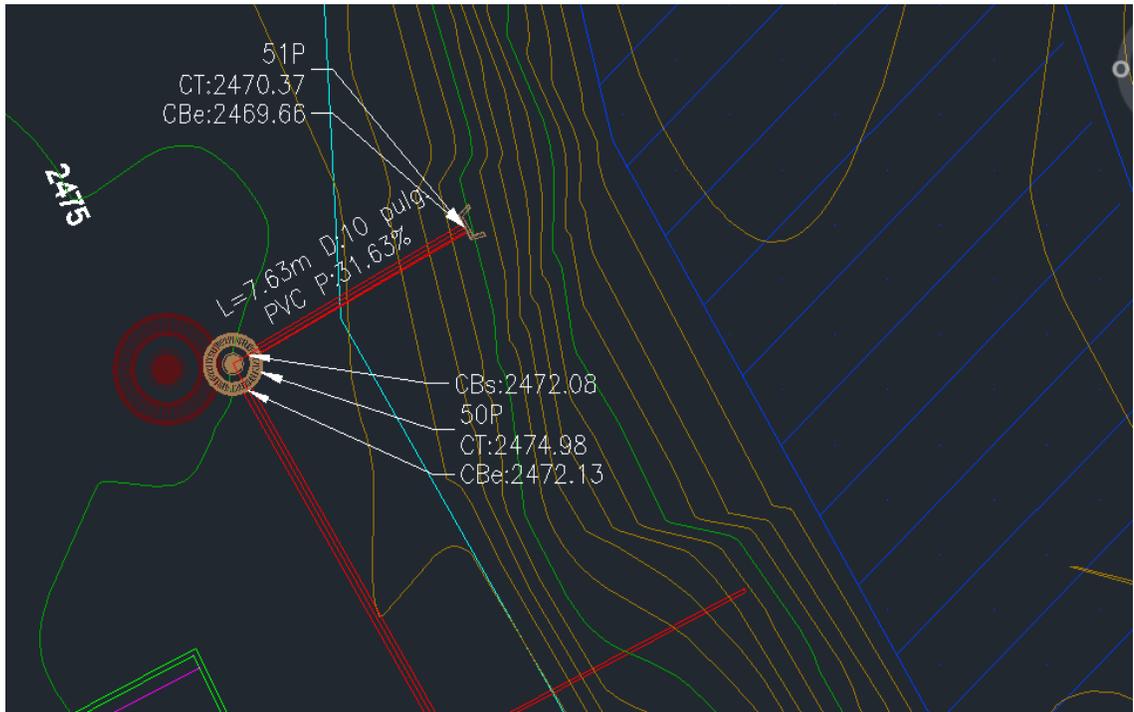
Diseño alcantarillado pluvial tramo 50P a Descarga
